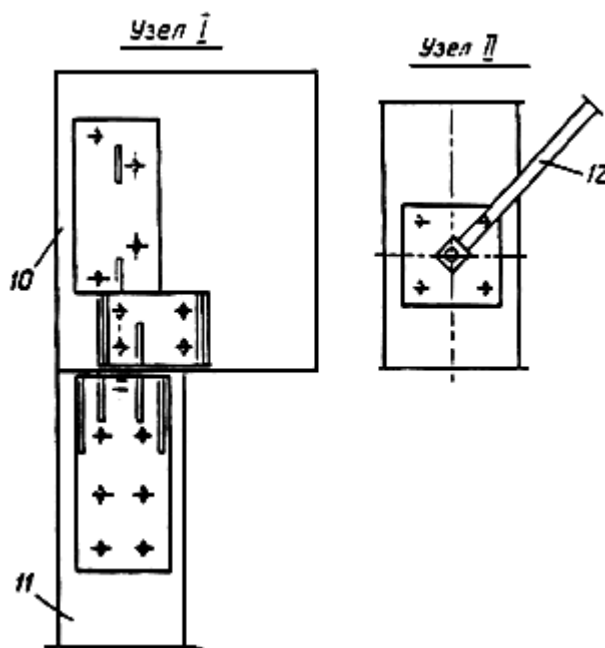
Схема организации строительной площадки (вариант I), узлы I и II
